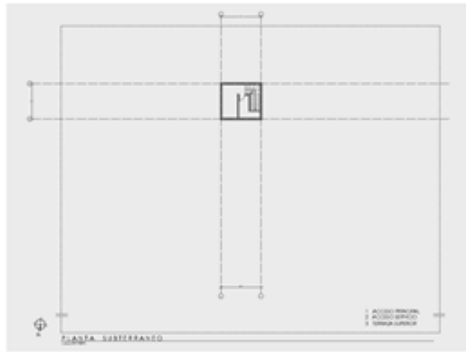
Planta de subterráneo redibujada. Fuente: Elaboración propia.
